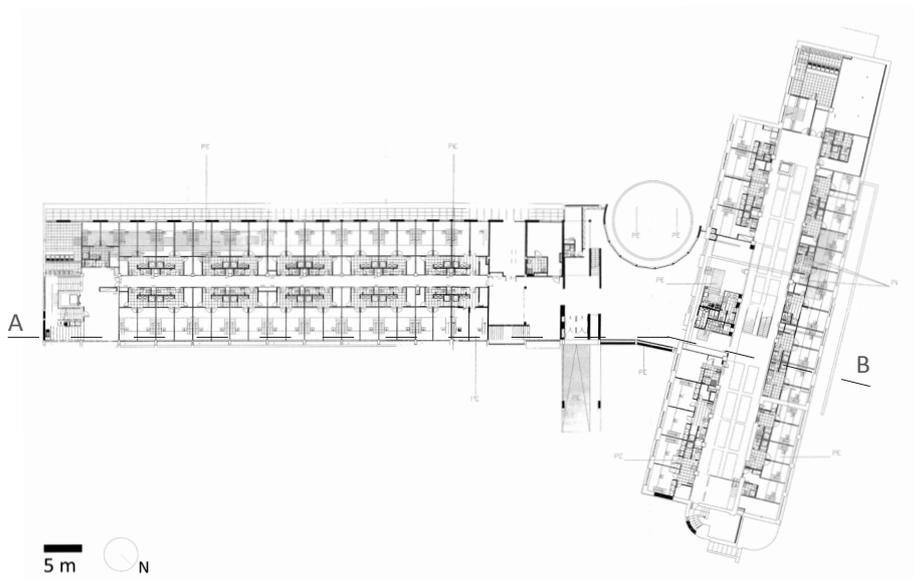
Residência Pedro Álvares Cabral - Complexo fabril João Roque Cabral: planta do piso térreo.
